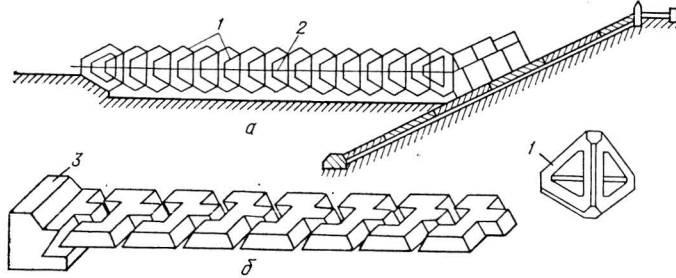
Сборные конструкции поперечных регуляционных сооружений: а — сквозная шпора из тетраэдров; б — гибкая полузапруды из железобетонных элементов; 1 — железобетонный тетраэдр; 2 — стальной соединительный трос; 3 — корневой блок.
